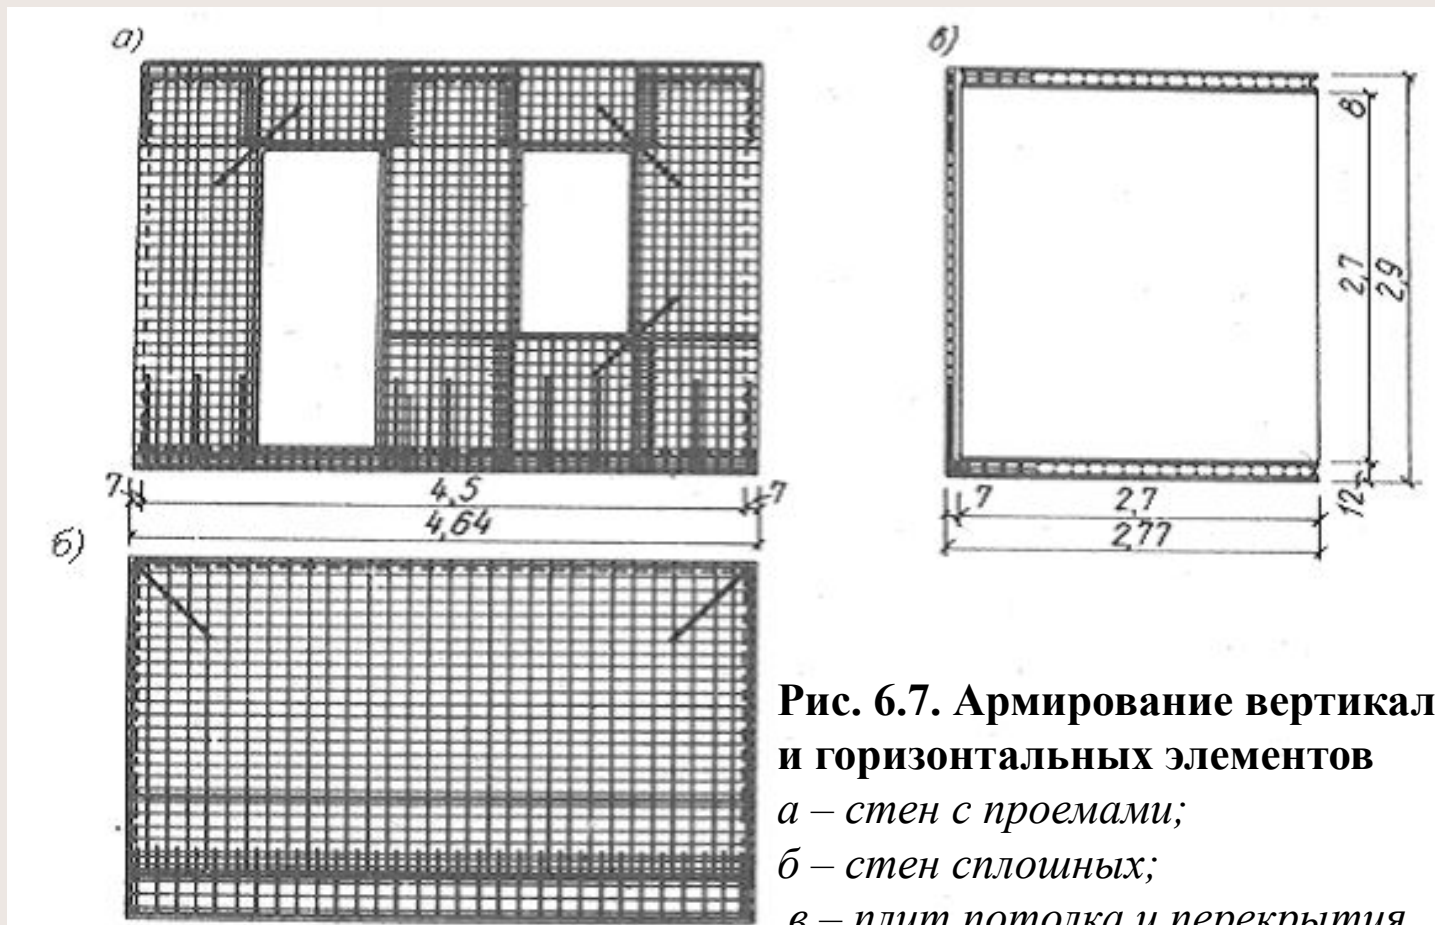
Армирование вертикальных и горизонтальных элементов
